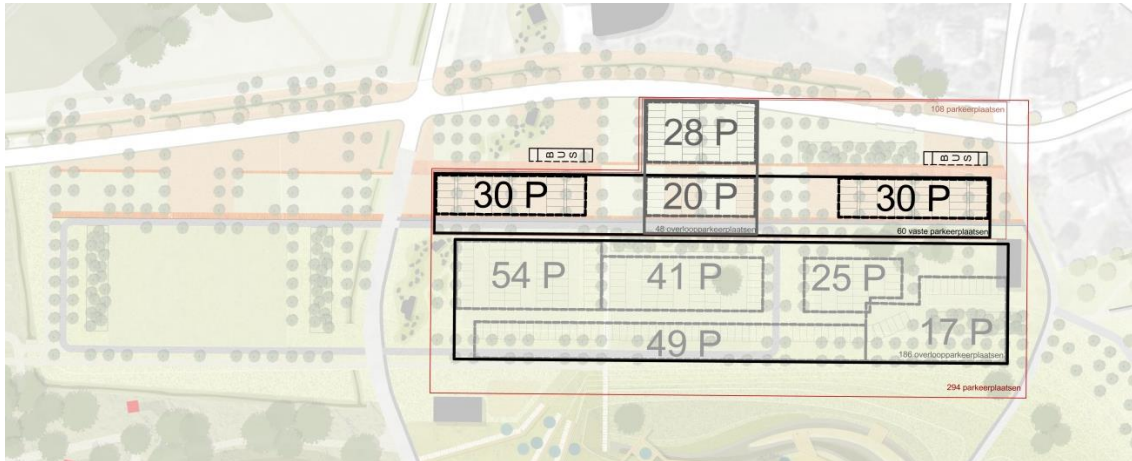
grondplan van de ontvangstruimte of Aleph (en parkfilter)
